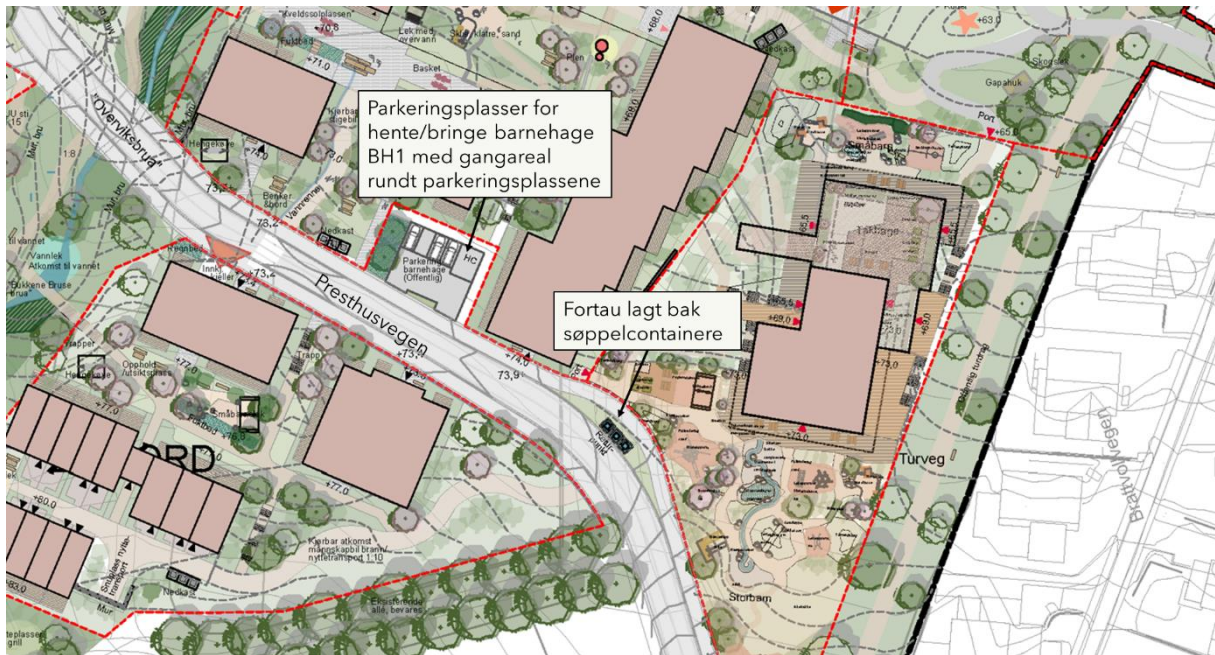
Gangsystem sør i planområdet (Kilde: Sweco Architects 06.12.2024)
